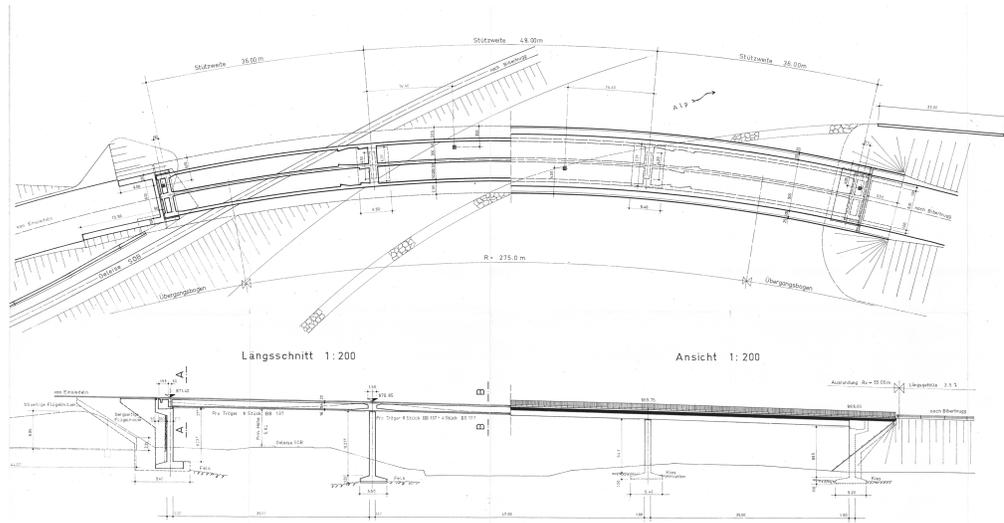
Grundriss und Längsschnitt der Holzrütibrücke
